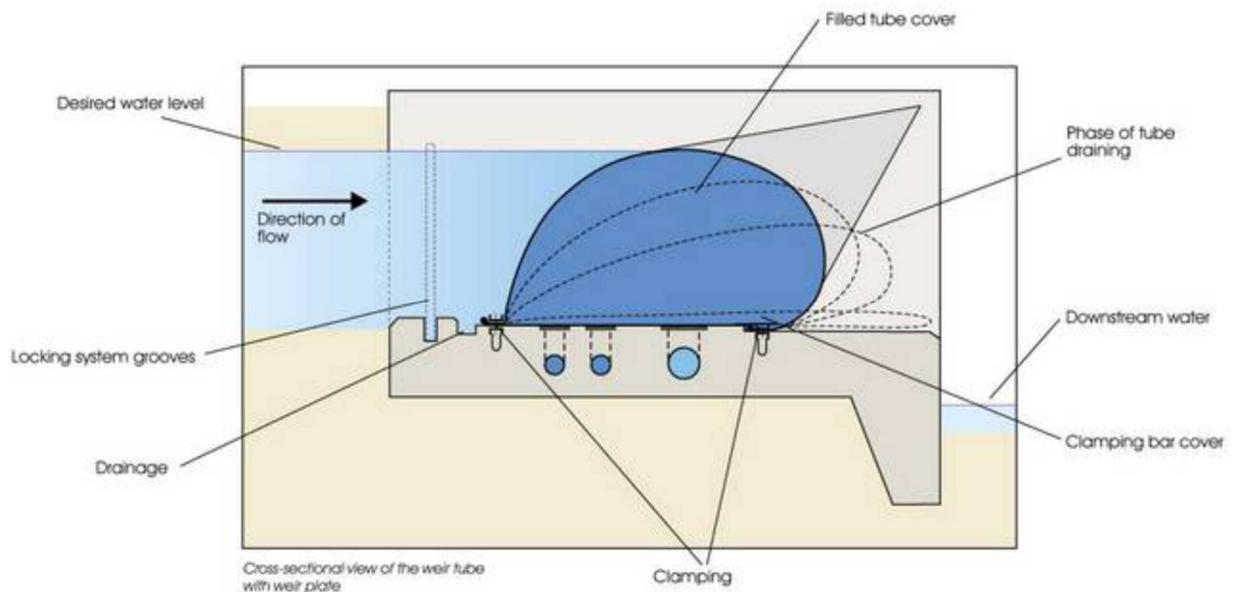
Schema sezione trasversale del tubolare e relativa traversa
